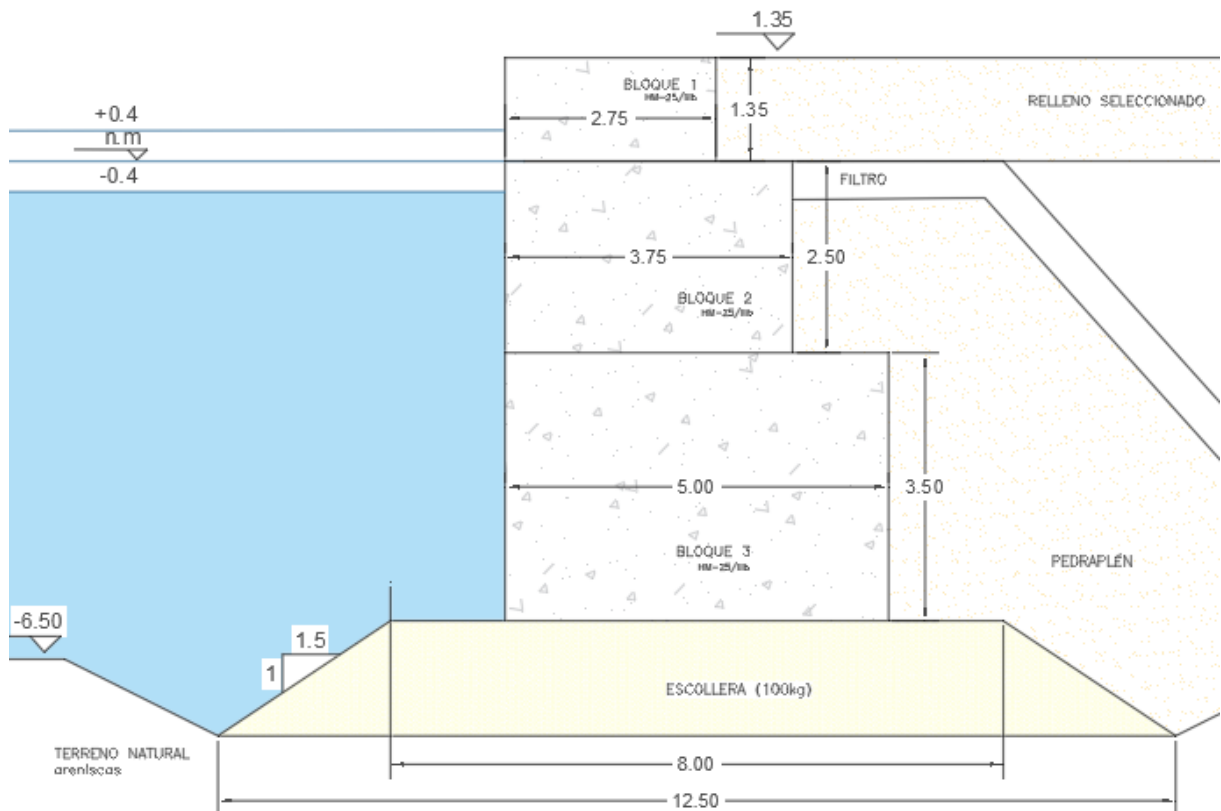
Sección del muelle planteada. (Fuente: Elaboración propia)
